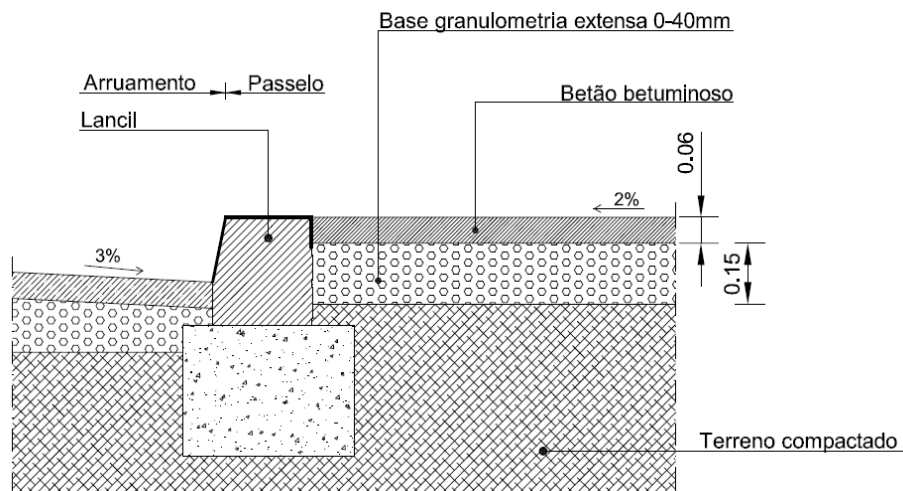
Estrutura de um pavimento em material betuminoso (MVNG, 2013)
